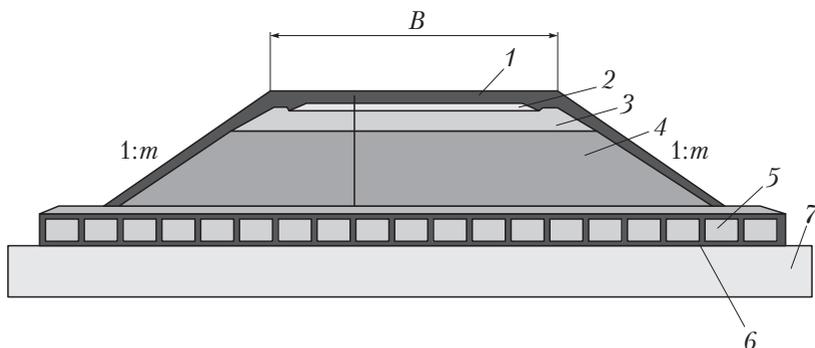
Пример совместного применения георешетки и геотекстиля при устройстве насыпи на слабом грунте: 1 — покрытие; 2 — несущий слой основания дорожной одежды; 3 — дополнительный подстилающий слой основания из песка; 4 — грунт тела насыпи; 5 — георешетка высотой  $h = 20$  см, заполненная песком  $h = 30$  см (количество слоев определяется расчетом); 6 — нетканый геотекстиль или высокопрочный геосинтетик; 7 — слабый грунт
